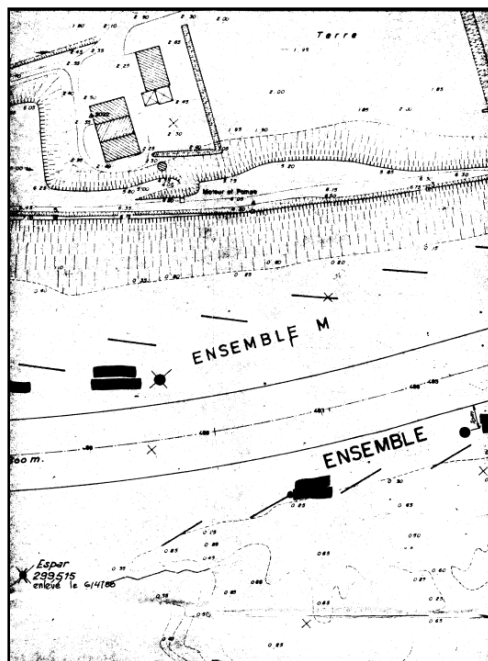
Localisation des panneaux de fond au PK 299.5 en rive droite et gauche (plan CNR 1982)
